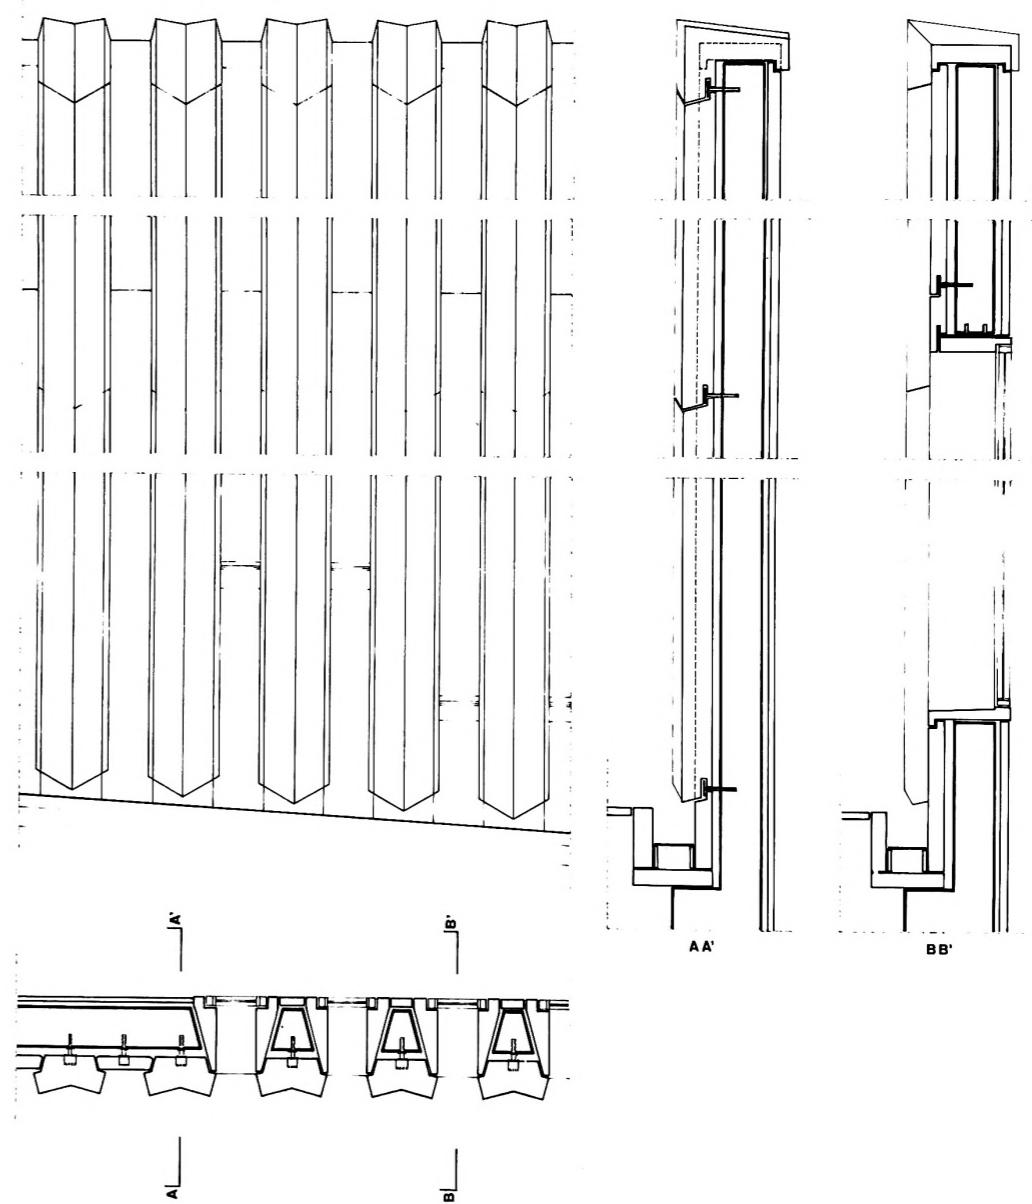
Plan, coupe et élévation du détail de principe de la façade, avant-projet du musée signal.
